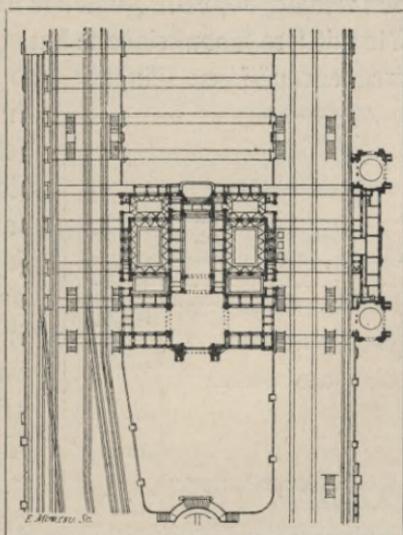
Plan des Dresdener Hauptbahnhofs in der Höhe des ersten Stockwerks aufgenommen.
